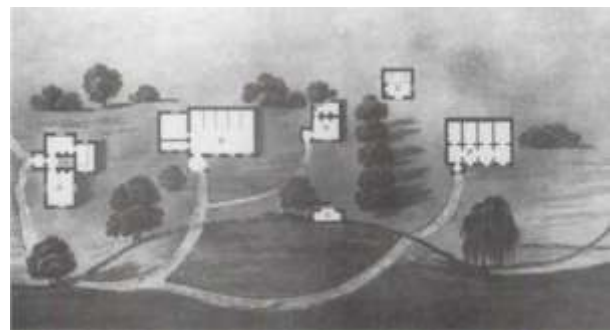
Desenho com a implantação de casas em Park Village.
